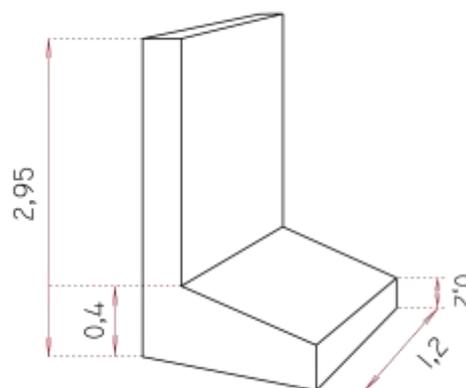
Подпорные стенки для штабелей угля
